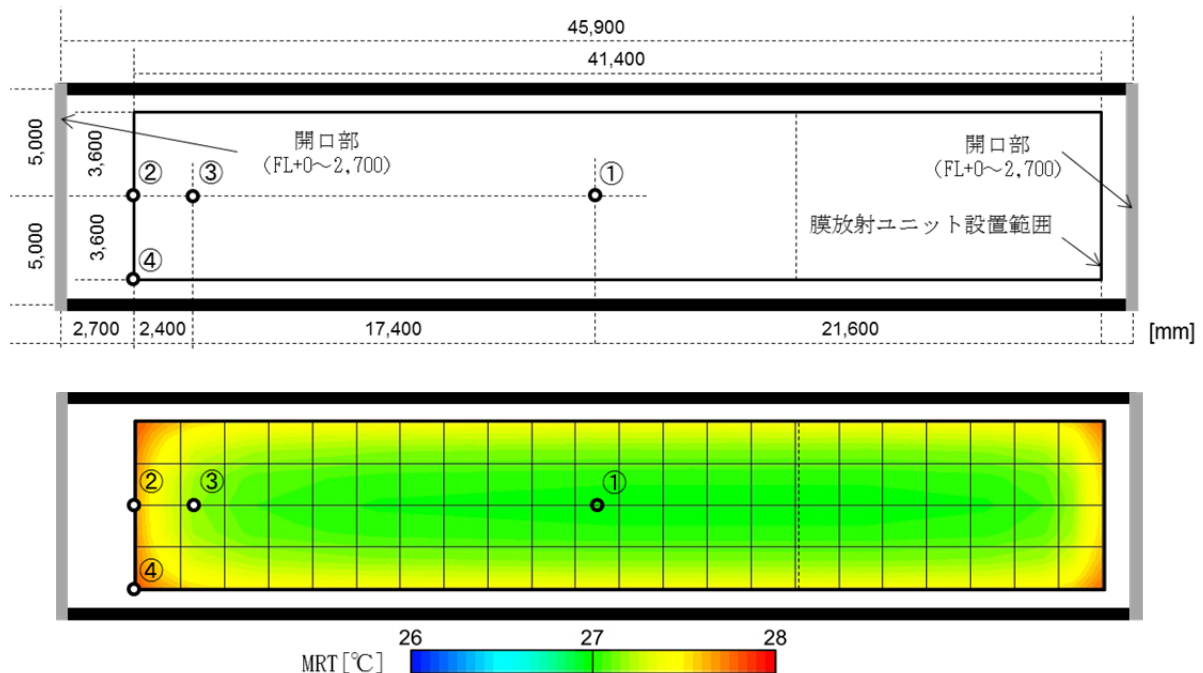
計測点平面図（上図）、MRT の等高線図（下図）
